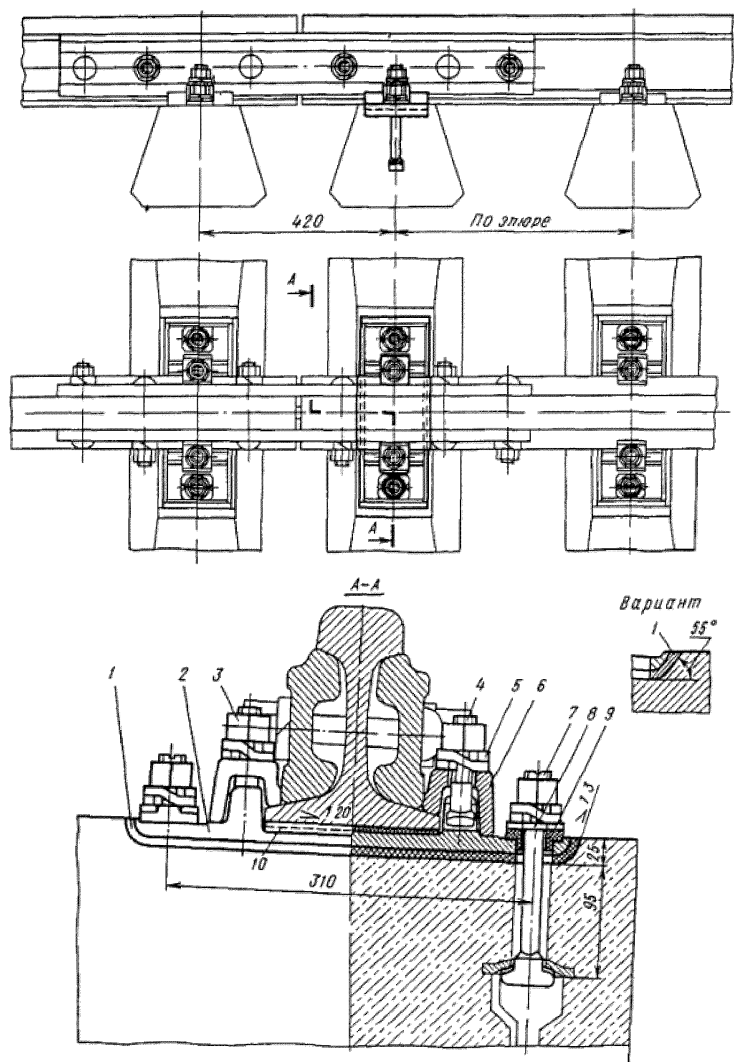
Стыковое и промежуточное крепление КБ-65 на железобетонных шпалах с рельсами Р65 и Р75:
